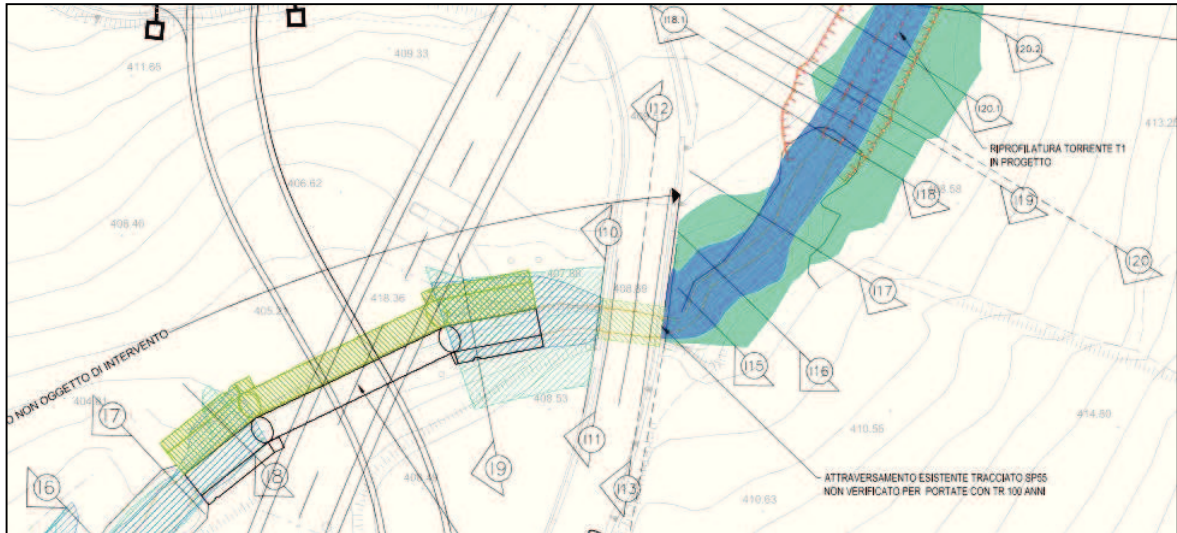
Stralcio planimetria aree esondabili torrente T1 stato di fatto e di progetto TR 100 anni – tratto in corrispondenza degli attraversamento delle S.P.55 e della S.P. 55 var.
